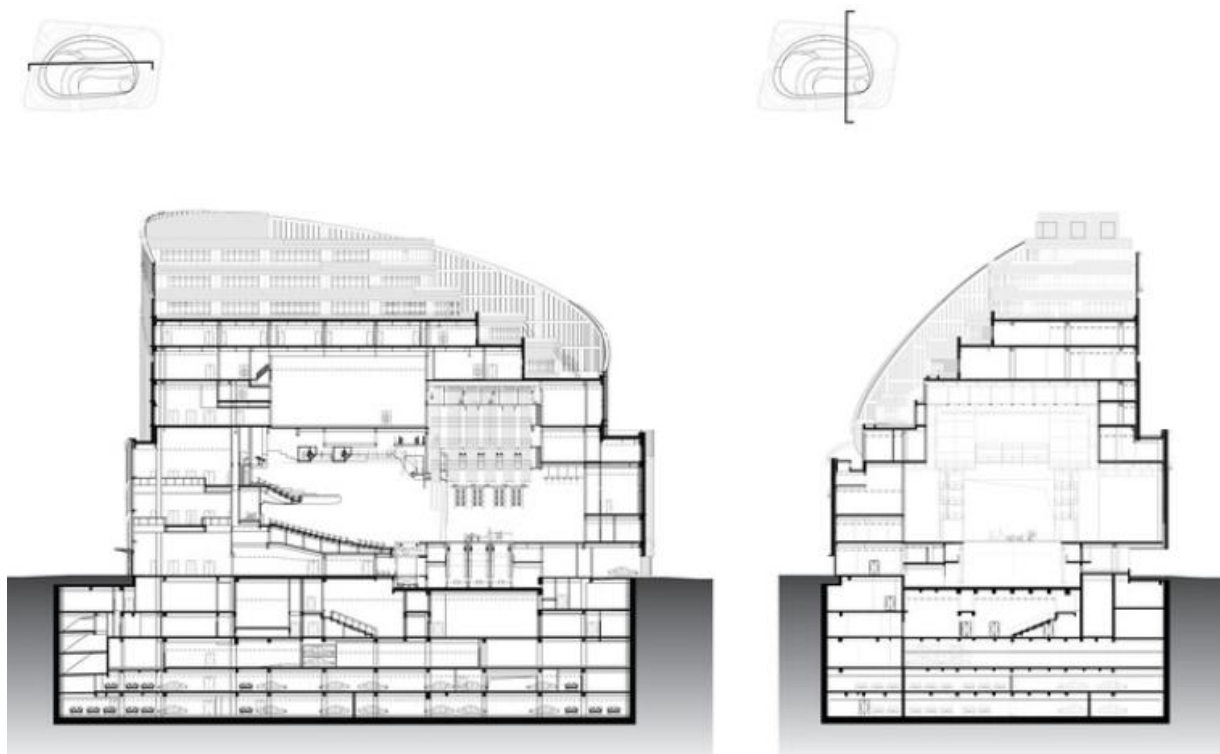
Розріз будівлі повздовжній рис; 2.14. Розріз поперечний; [28].
